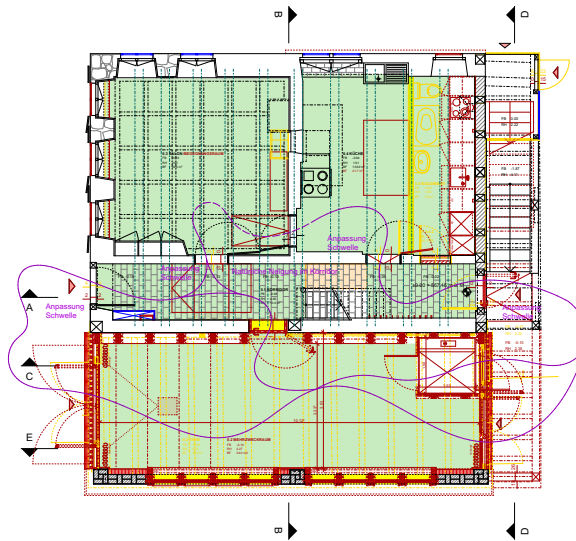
Grundriss EG Zugänglichkeit Konzept
